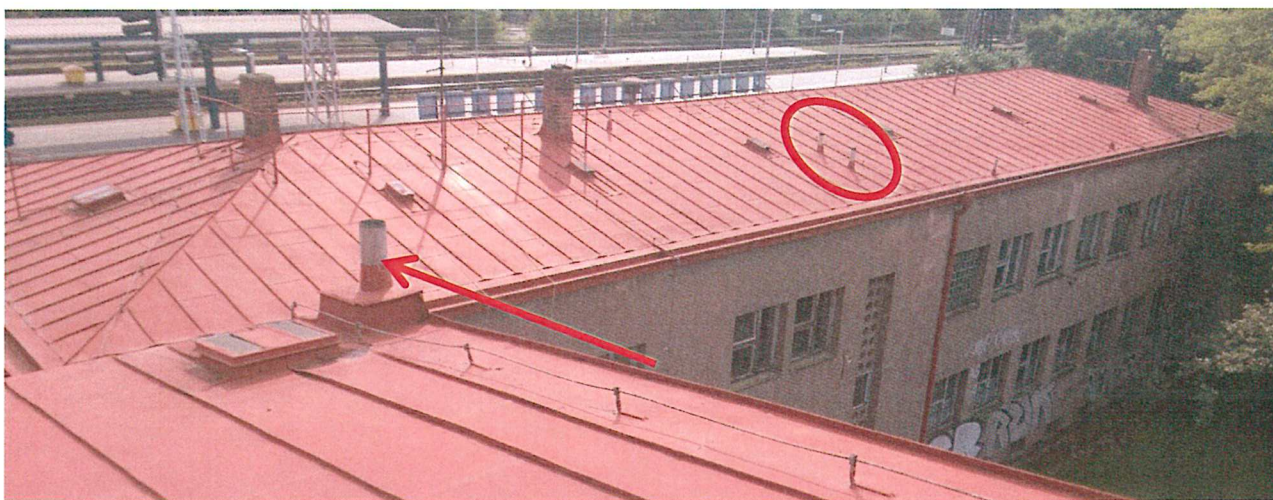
Pohled ze střechy odbavovací haly na technickou budovu SSZT.
